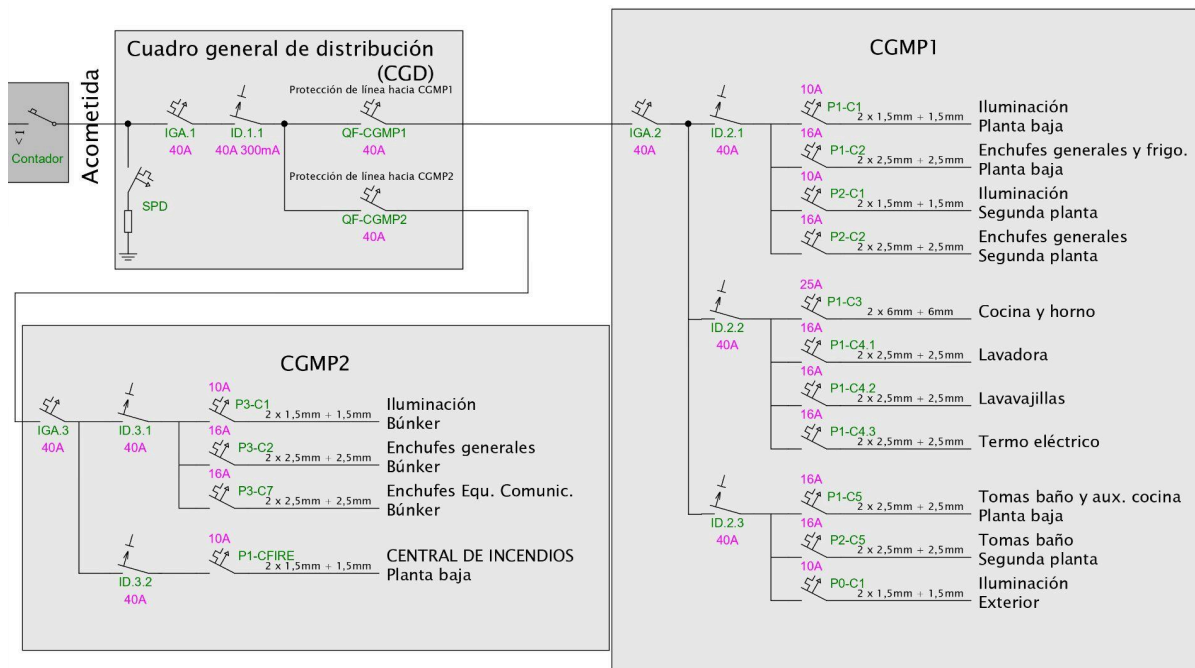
a Esquema montaje del cuadro eléctrico.
